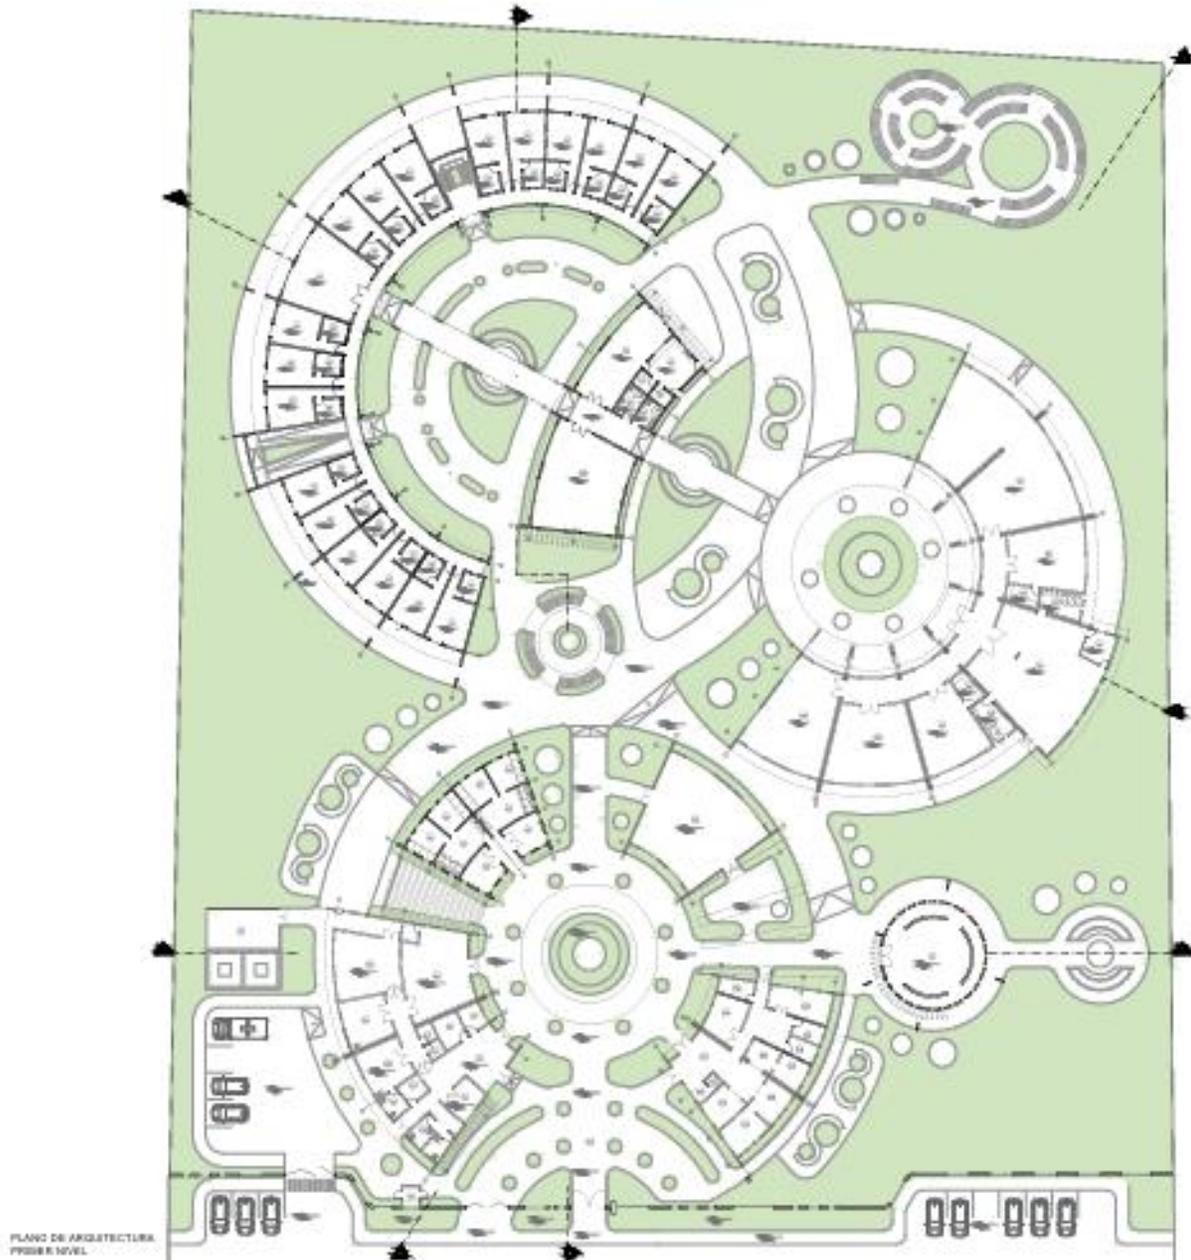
Plano de zonificación a nivel macro – Primer piso
